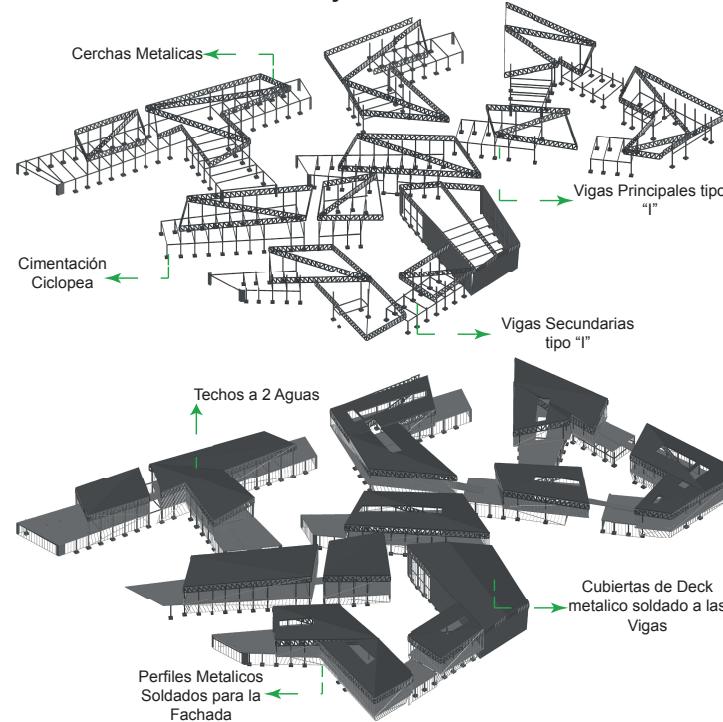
Tecnología y Sistema Constructivo Usado en el Proyecto Final
